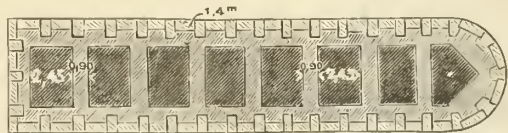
Grundriss eines Pfeilers in Höhe des Hochwasserspiegels.
